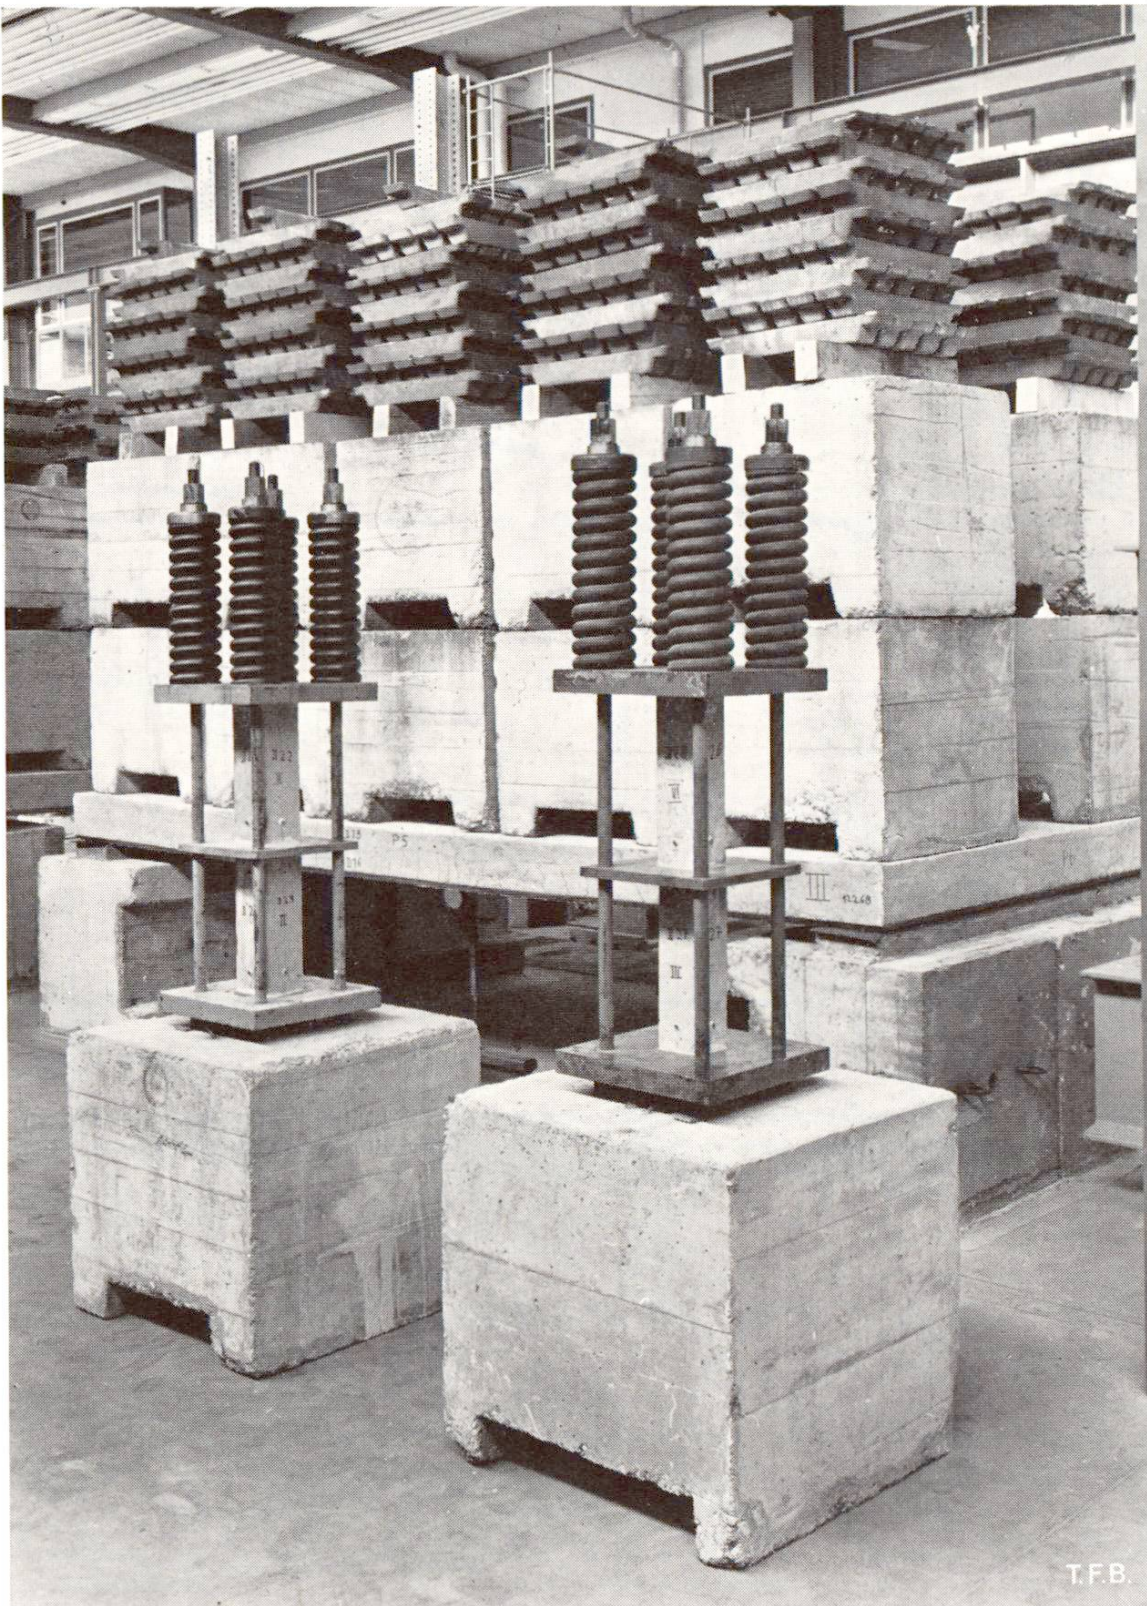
Stahlbetonplatte III, zentrisch gedrückte Betonprismen.
